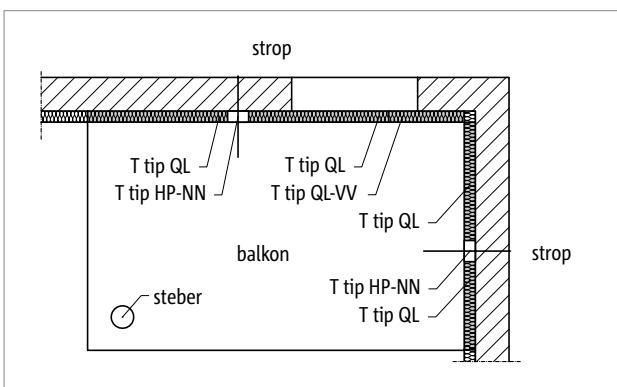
Schöck Isokorb® T tip HP: balkon z ležajenjem na steberih
